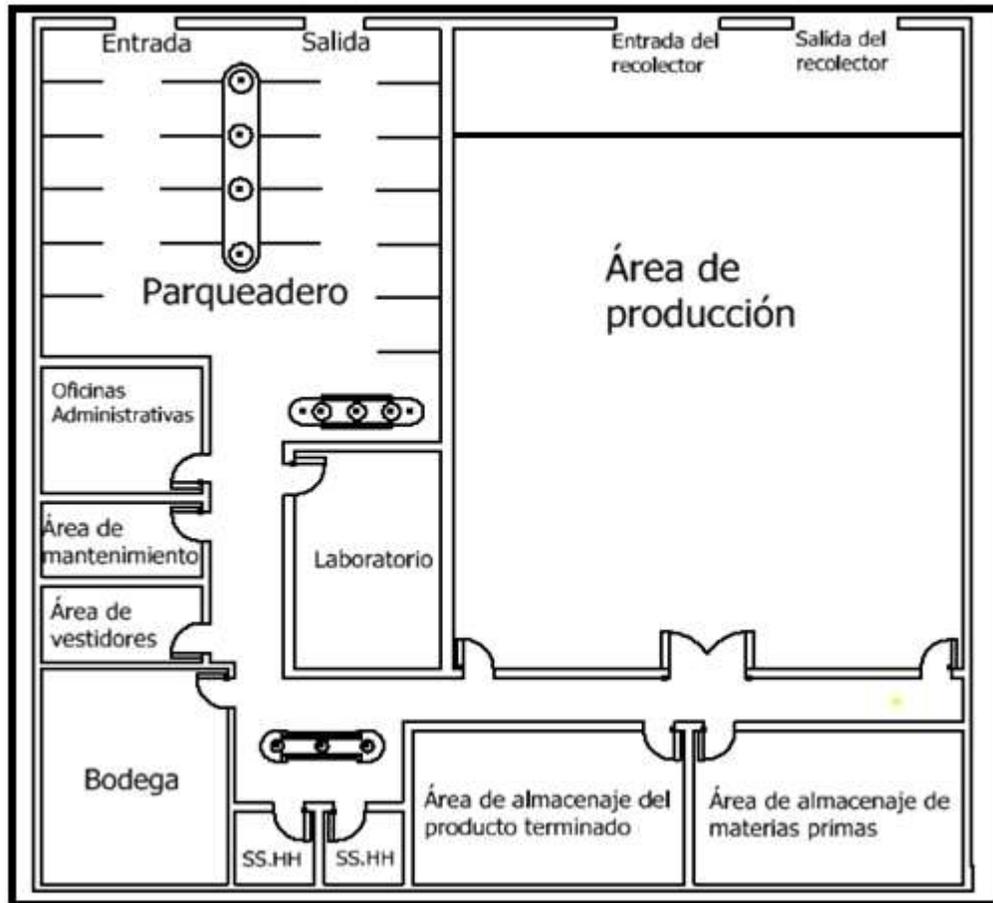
Distribución de la planta. Fuente: (Autores)
